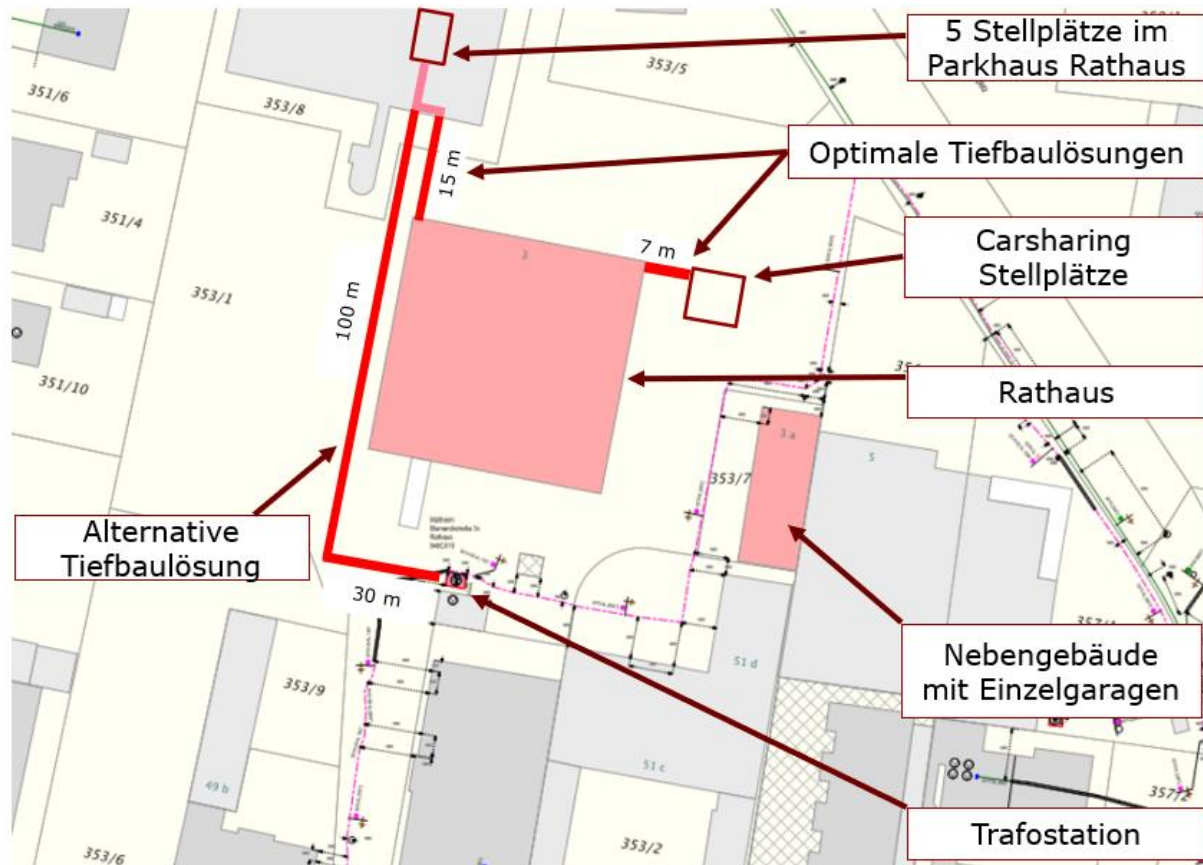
Grundriss Rathaus mit Umgebung
